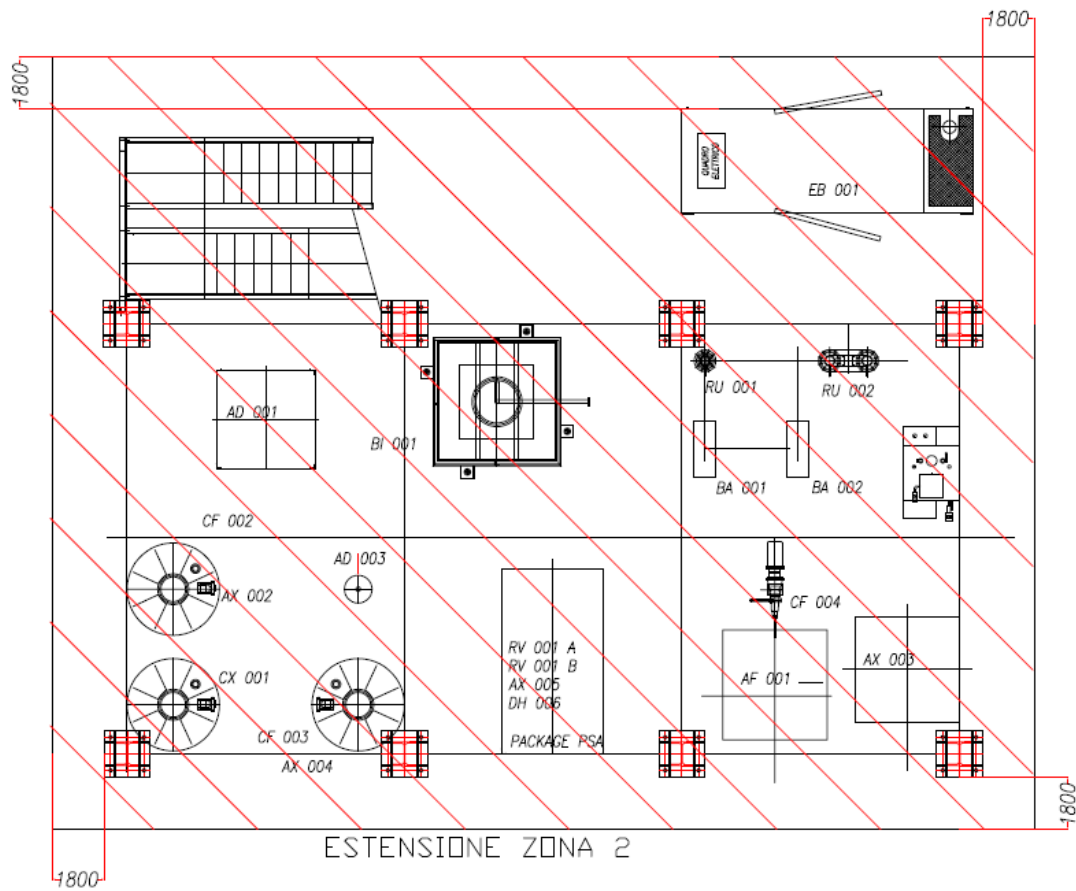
Estensione della zona 2 ATEX per il piano terra dell'impianto Pilota
